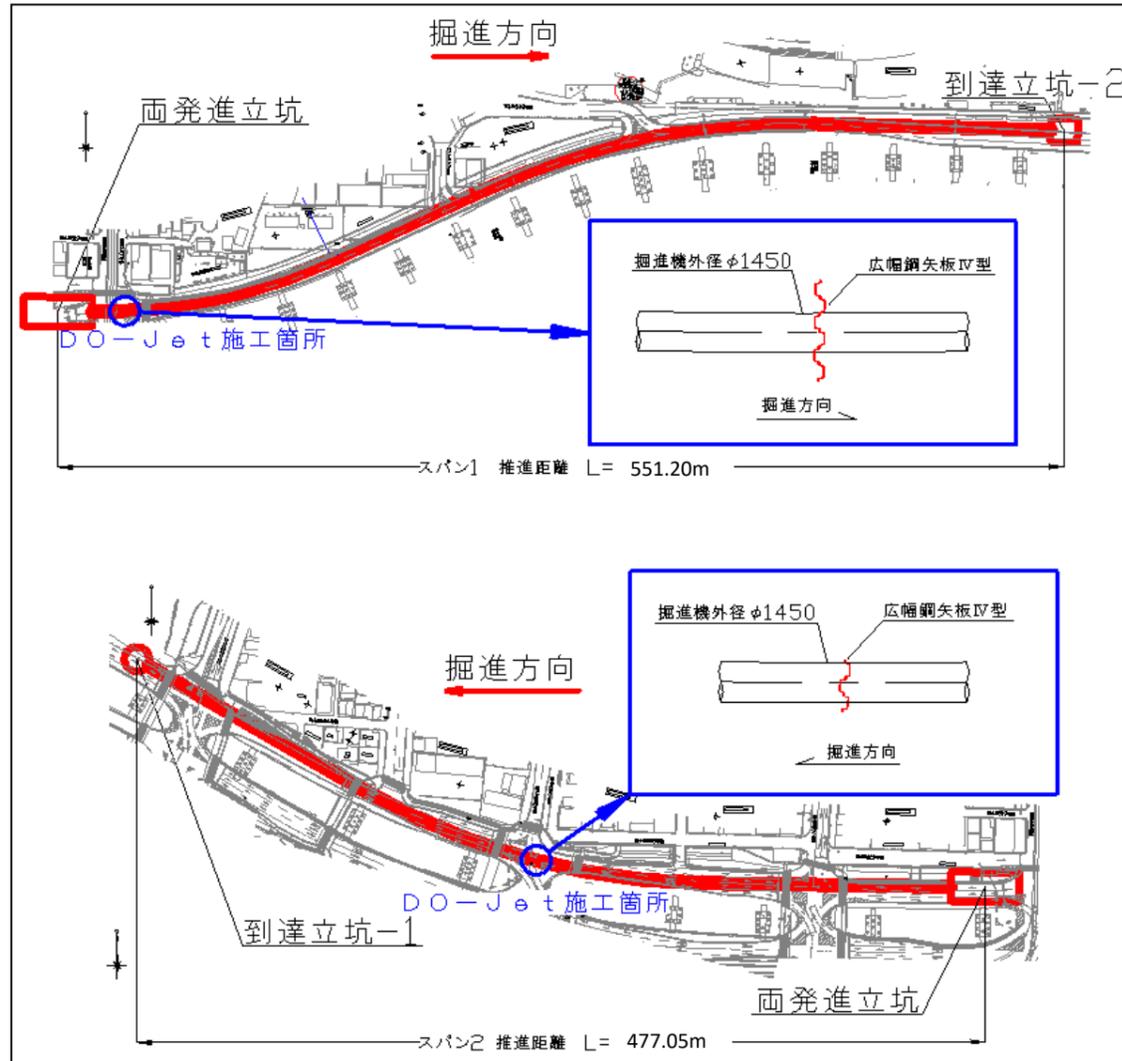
推進路線及びDO-Jet工法施工箇所詳細図
